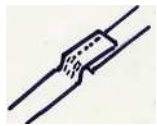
plaques planes d'étanchéité des interstices entre plaques du toit (au cas où les joints d'étanchéité ne suffiraient pas). Elles peuvent être en plastique ou un métal non corrodable (aluminium ou inox). (B).
